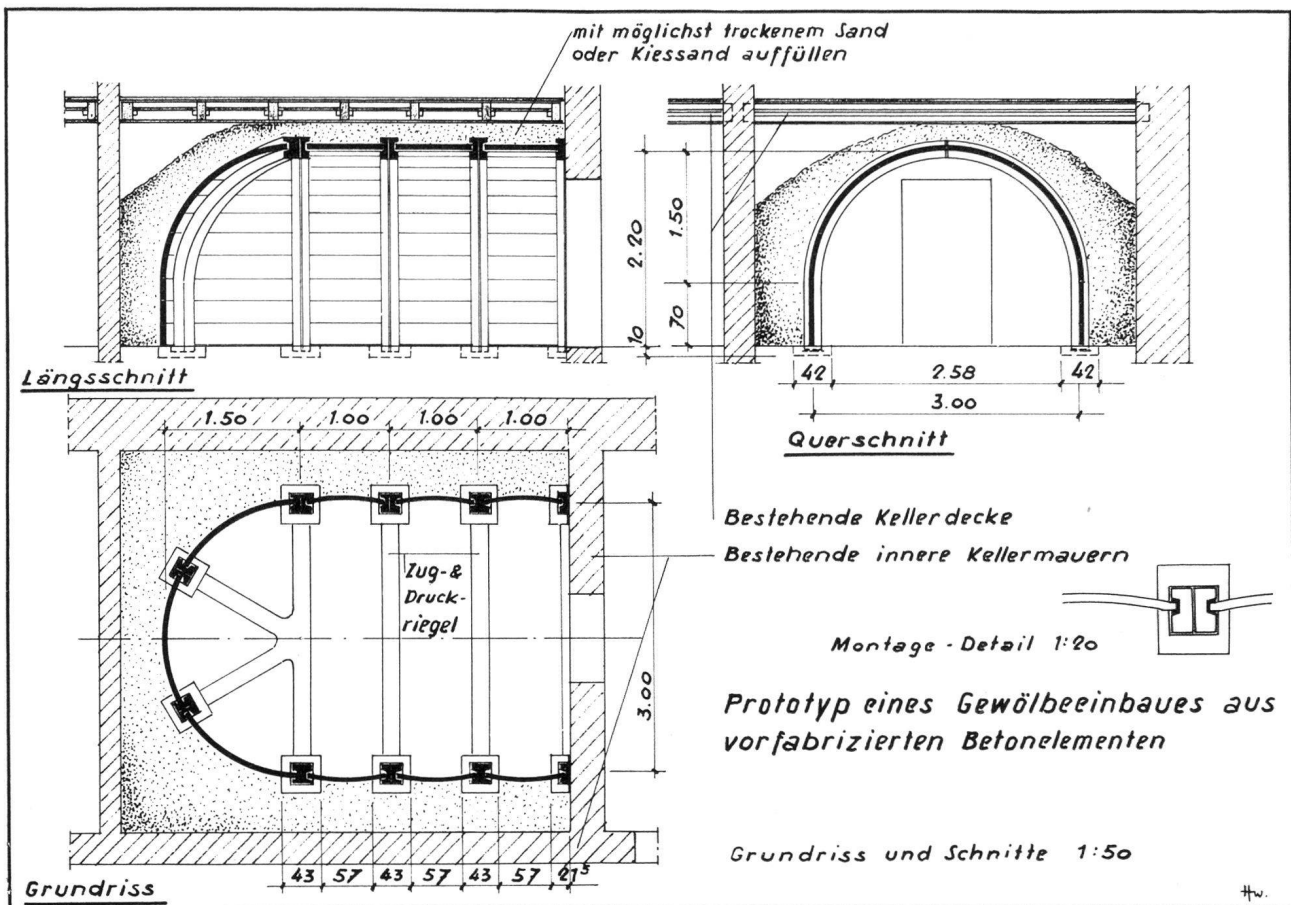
Verstärkung bestehender Keller für Schutzräume mit vorfabrizierten Betonelementen
